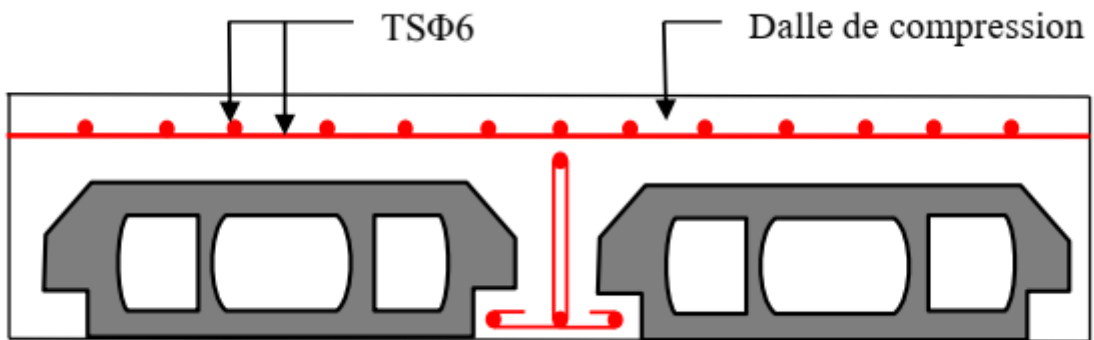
Schéma de ferrailage de la dalle de compression.
